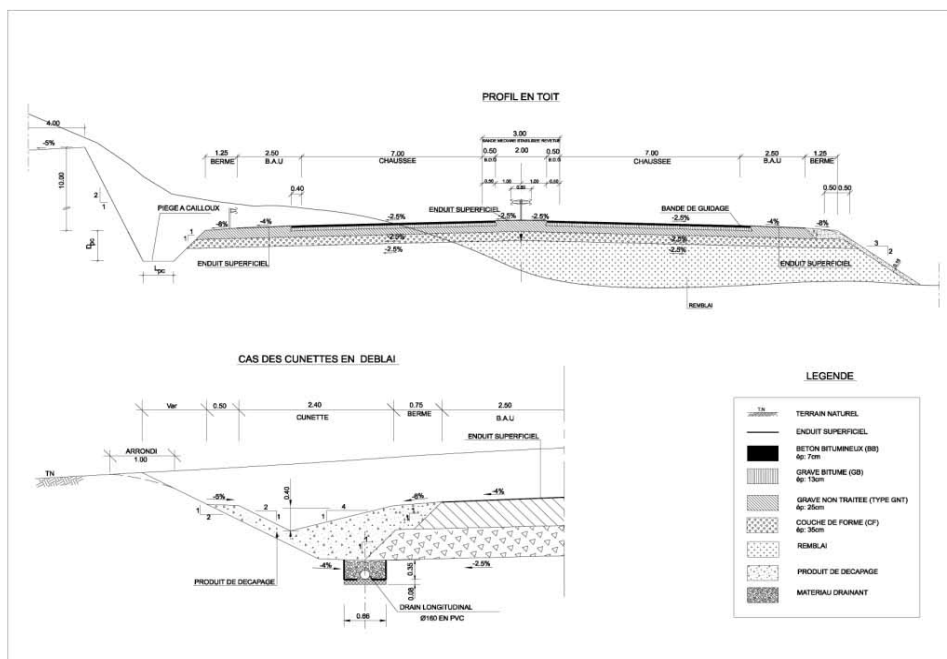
Profil en travers type de l'autoroute Marrakech – Agadir
